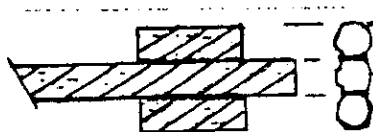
CABEZA DE ANCLA CON APOYO SOLDADO
